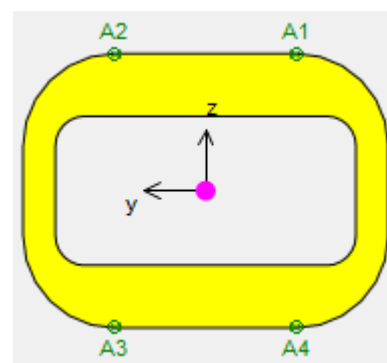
Sezione trasversale pila-spalla.
